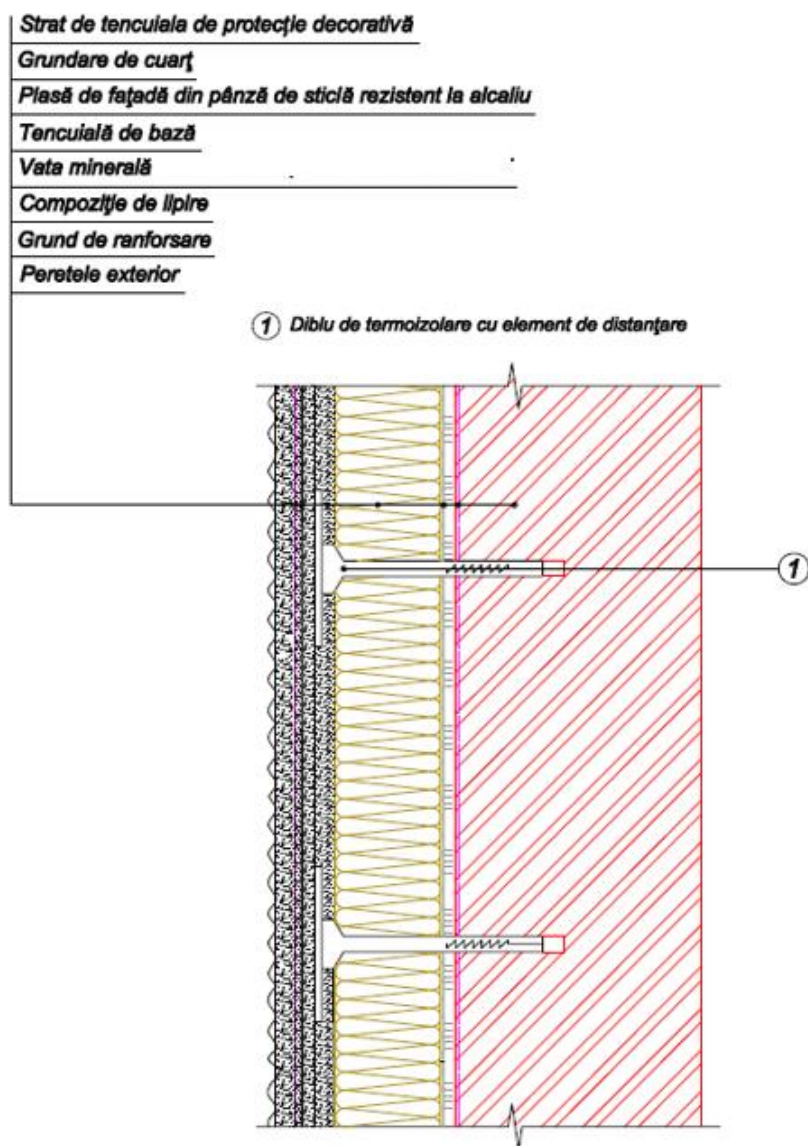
Aranjarea straturilor în sistem de termoizolare, profil vertical
